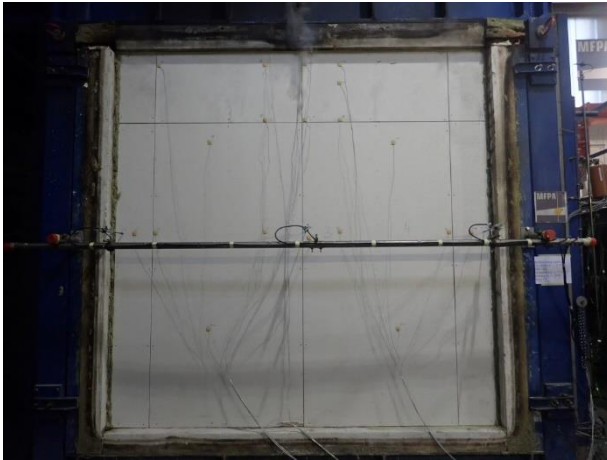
Prüfminute 16 – Risse öffnen sich und Platten der äußeren Lage stehen ab.
